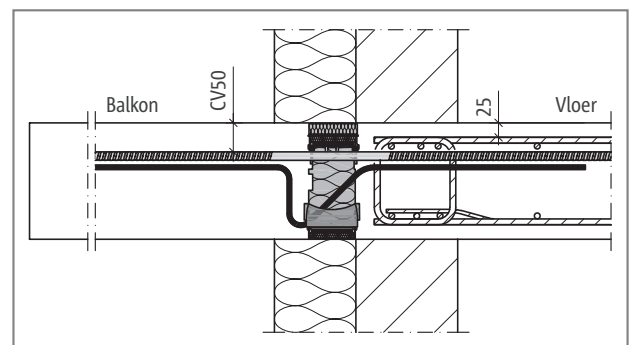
Schöck Isokorb® CT type K-T: aansluiting bij dubbelwandig metselwerk met kernisolatie
